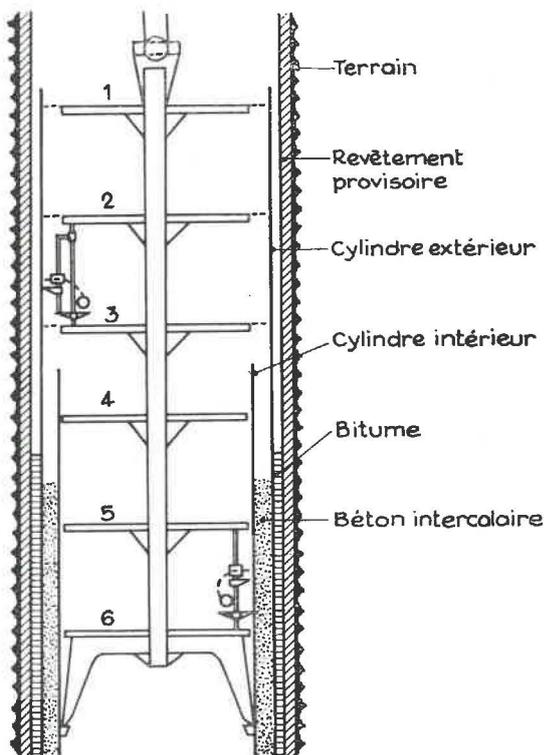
Disposition plus perfectionnée des planchers de travail dans le puits.
